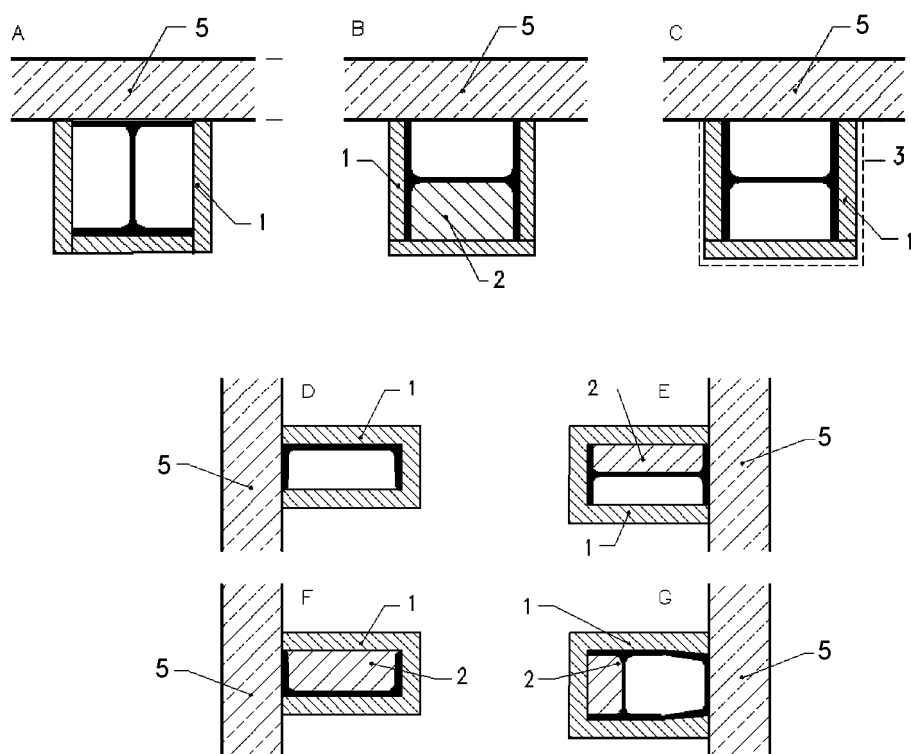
Encuentros estructurales de muros cortafuegos con muros y forjados
